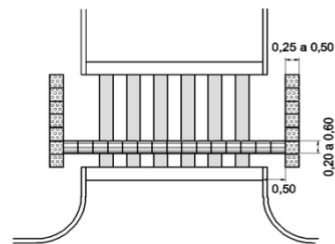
Faixa elevada com sinalização tátil de alerta e direcional – Exemplo
